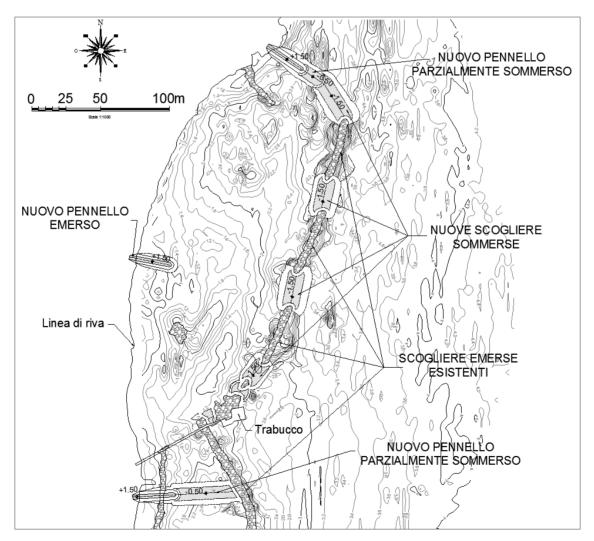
Planimetria di progetto delle opere di difesa in località Il Cavalluccio.
